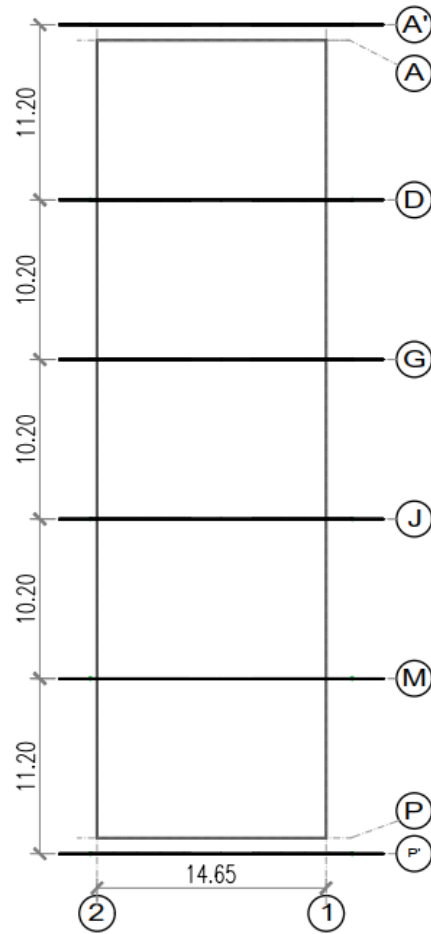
Planta de ejes y distribución de cuerdas en paralelo.
